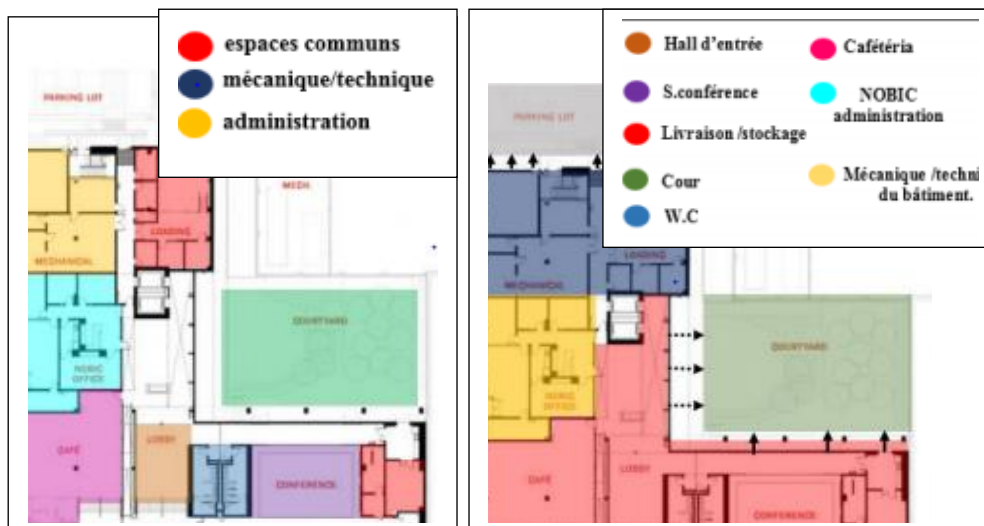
plan de RDC de bio centre innovation/Source: <http://www.aiatopen.org/node/447>
